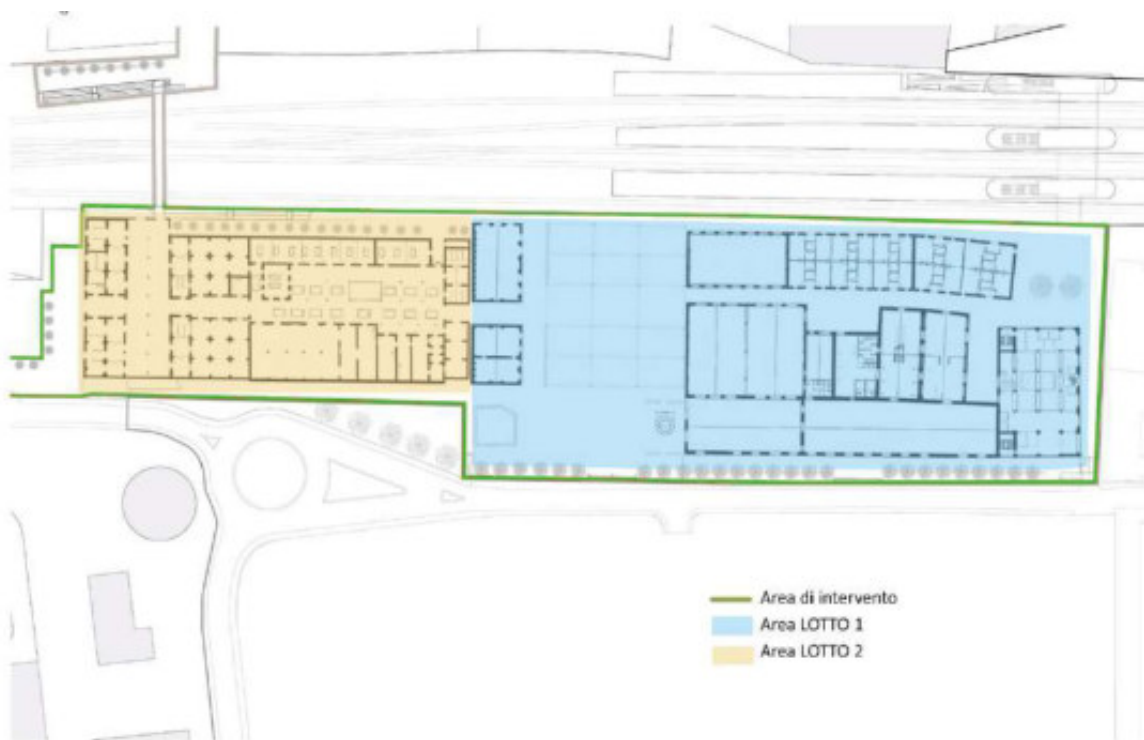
Area ex Corradini, piani terra. Individuazione Lotto 1 e Lotto 2.
